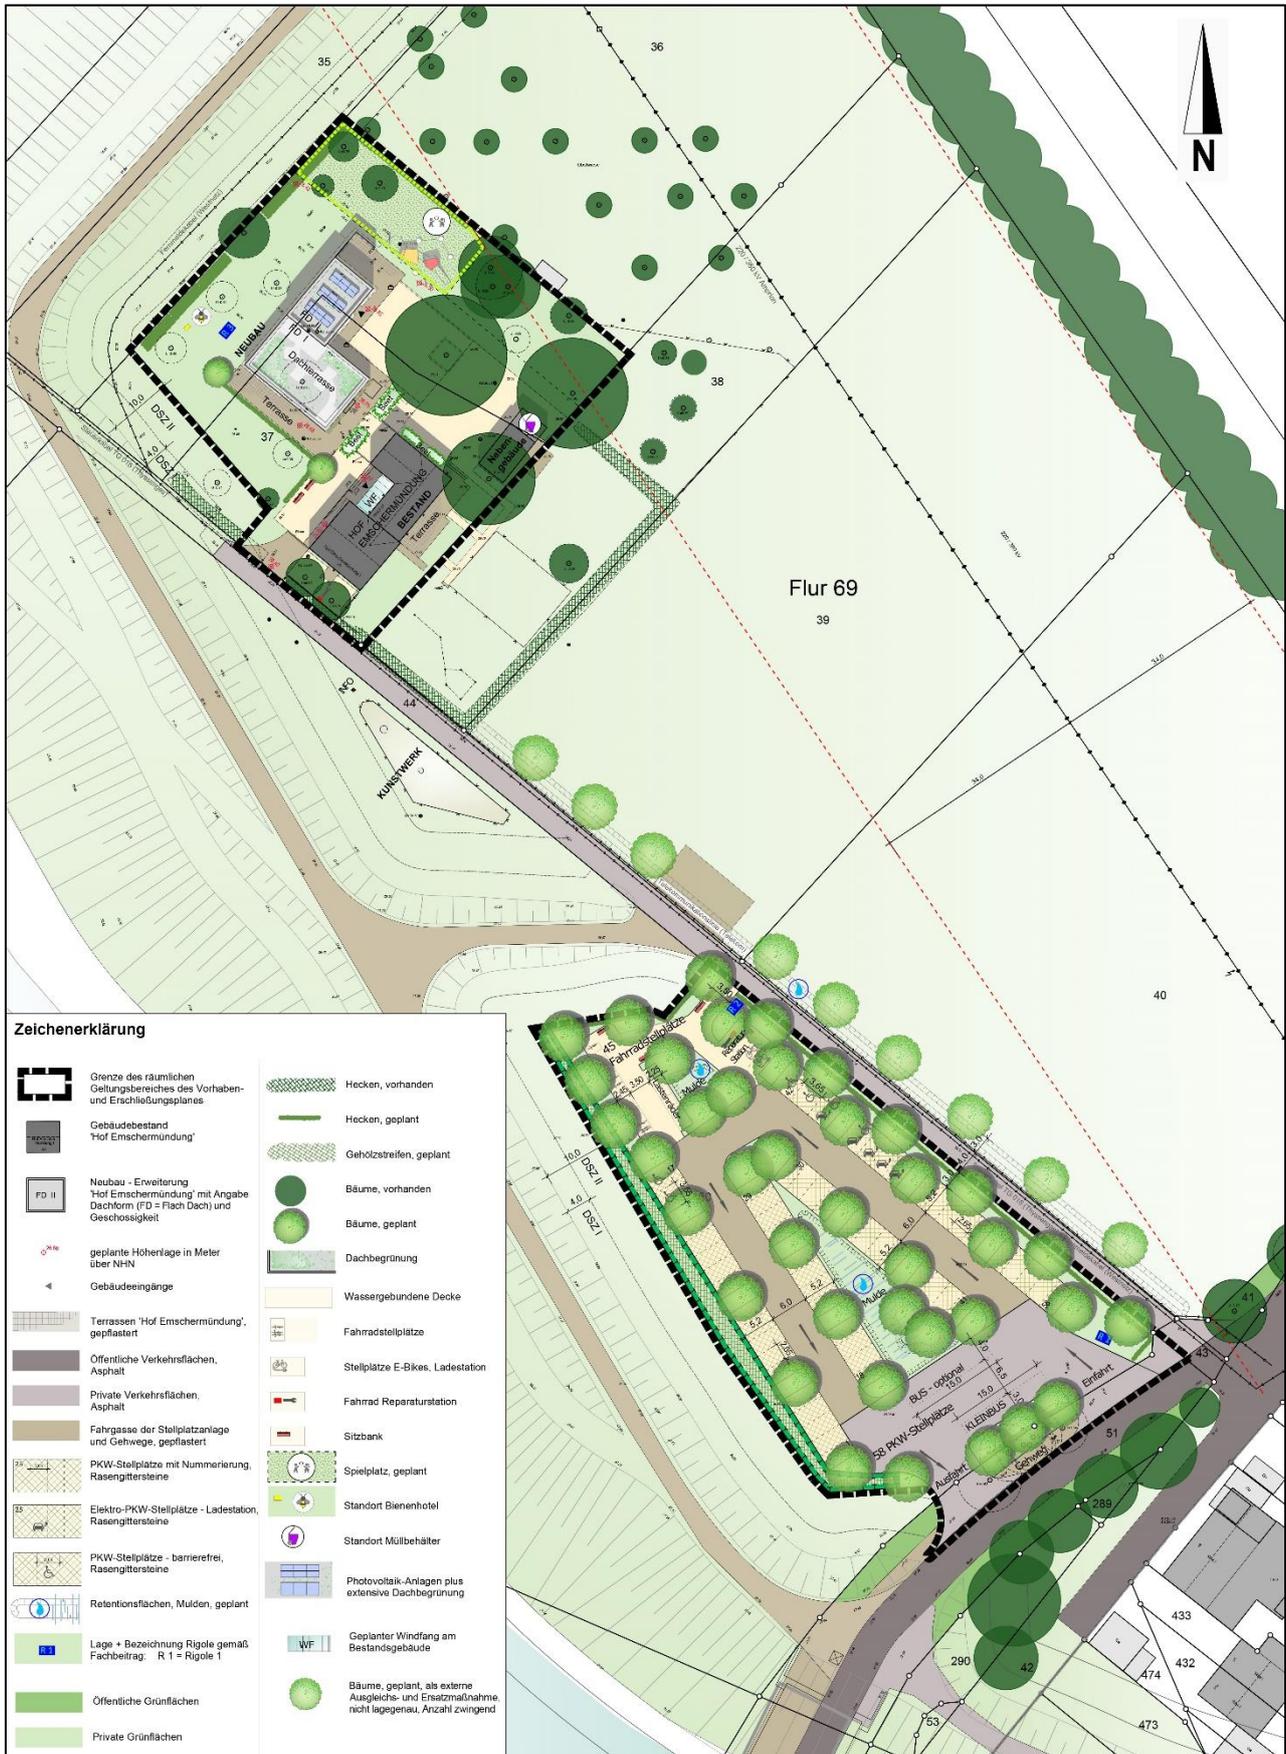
Städtebaulicher Entwurf/ Vorhaben- und Erschließungsplan (April 2025, Planquadrat Dortmund), genordet + ohne Maßstab
